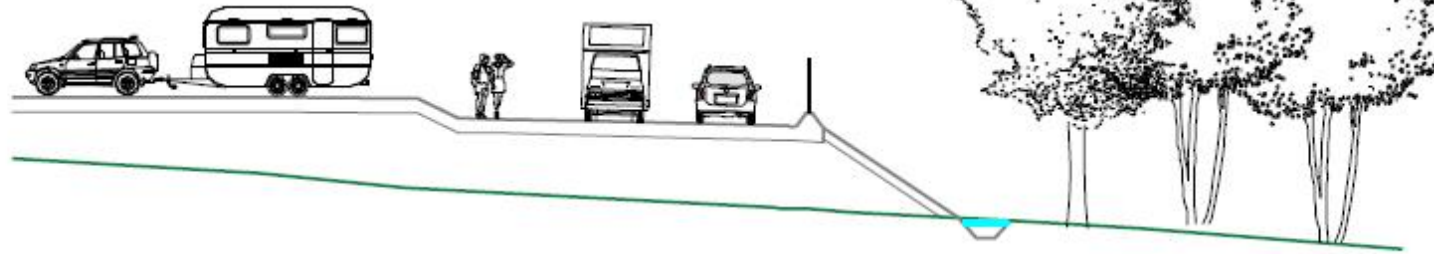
Plan d'implantation et coupes en travers au droit des merlons (03/2024, GBM)
